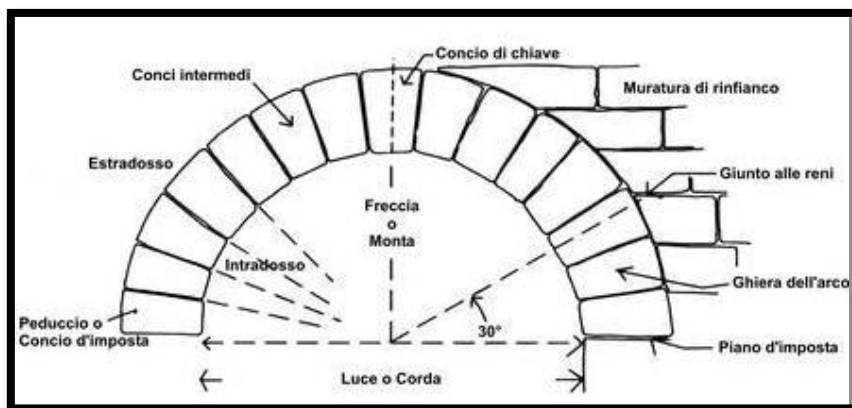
Schema strutturale dell'arco. (Fonte: BAGGI, G., 1926.)
